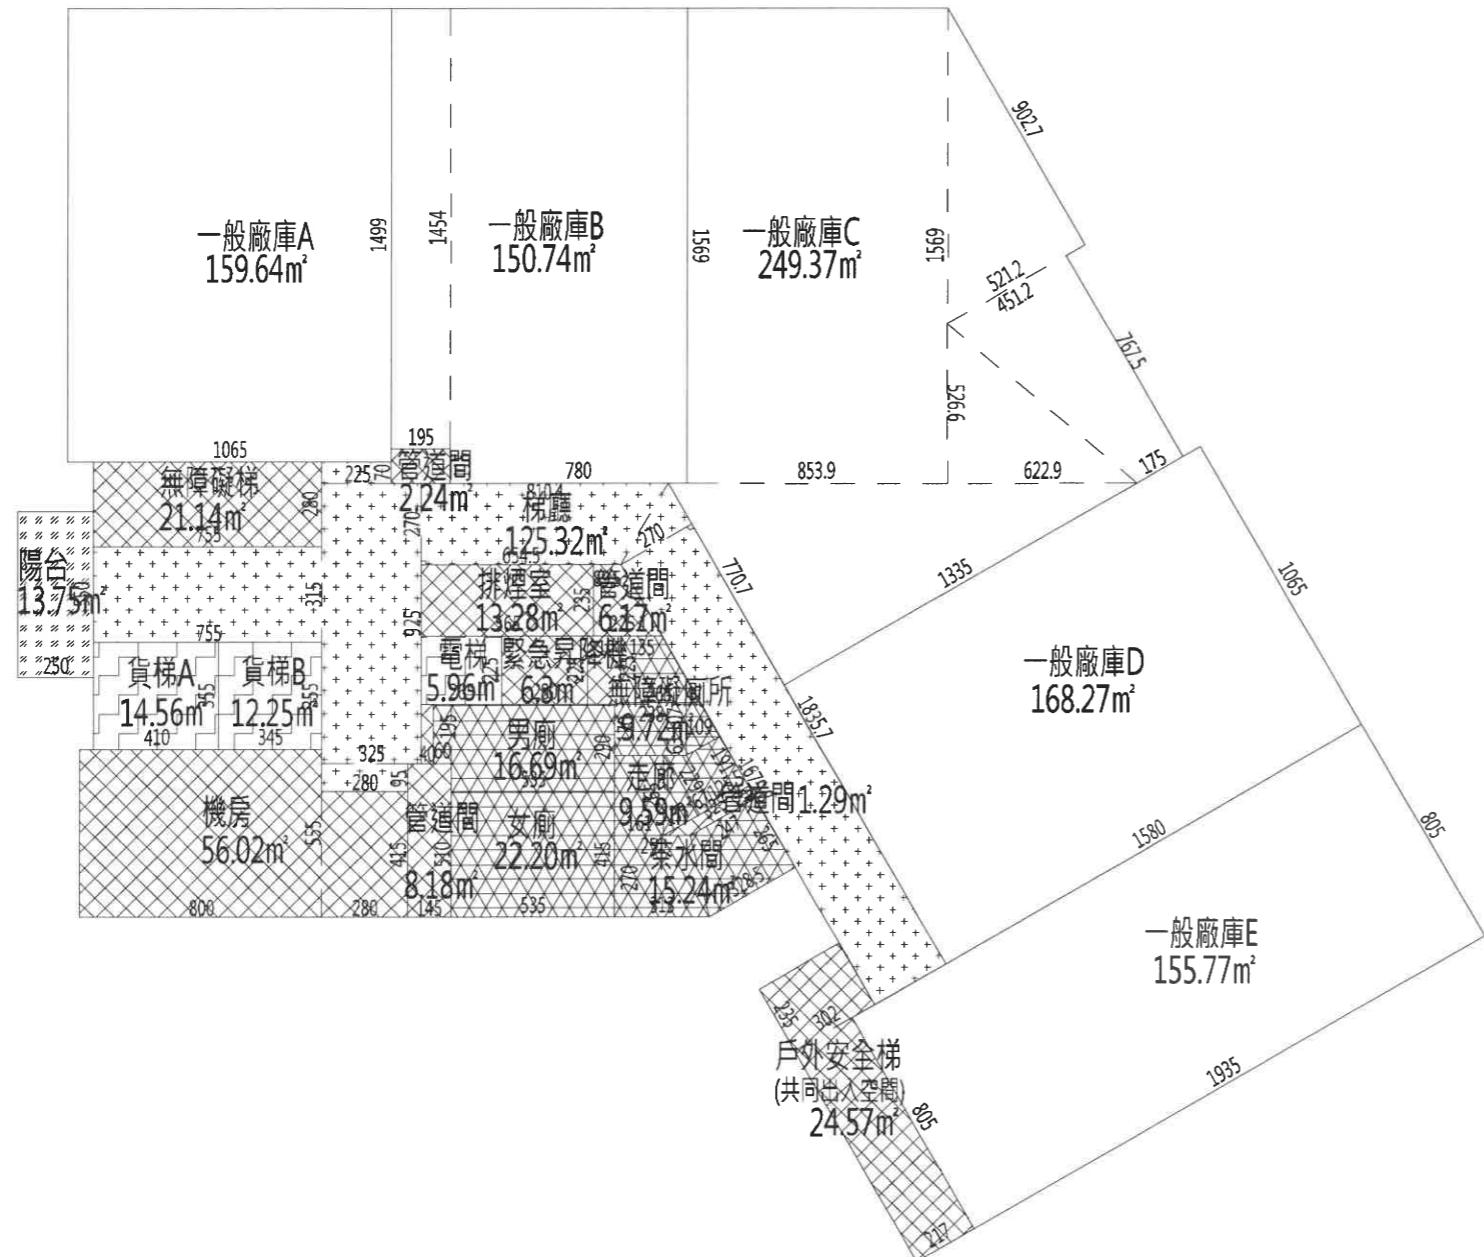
地上七層平面圖(變更後)(S : 1/300)
